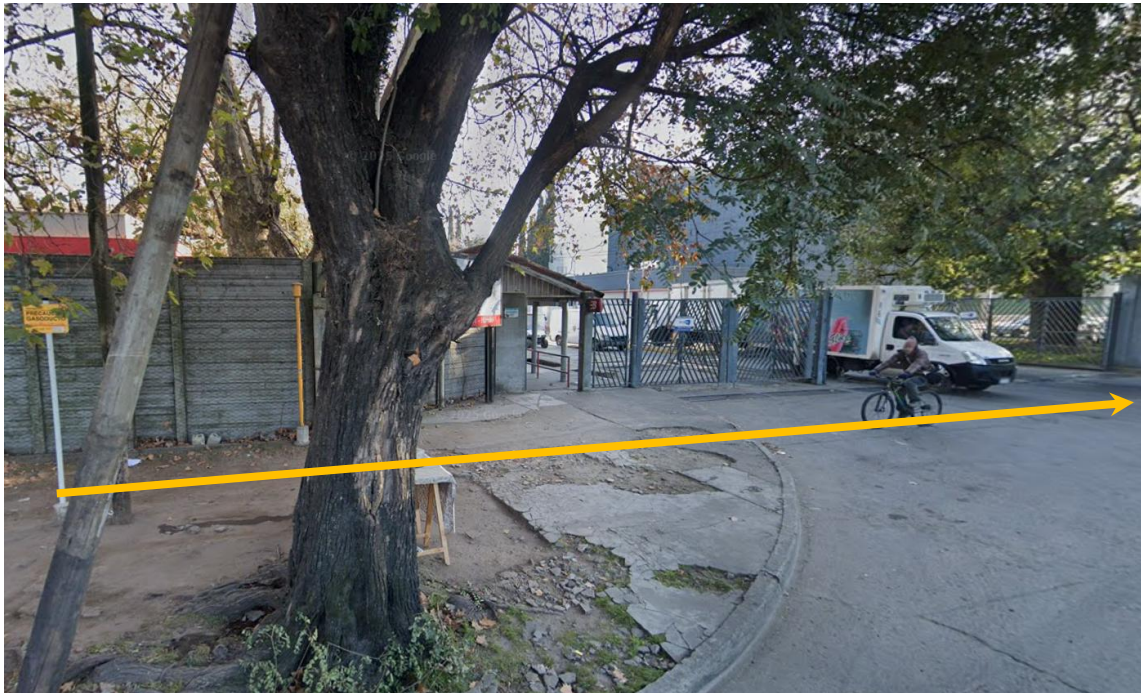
Vista en detalle sobre calle Valentín Gómez N° 151, donde se observa el acceso al Parque Industrial Morón (con paredón y portón de acceso restringido) y de la señalización de la infraestructura de gas natural existente en el área, con la cartelería indicando “Precaución gasoducto existente”. También se verifica la existencia de ejemplares del arbolado urbano, calle asfaltada y con cordón cuneta, y vereda.
